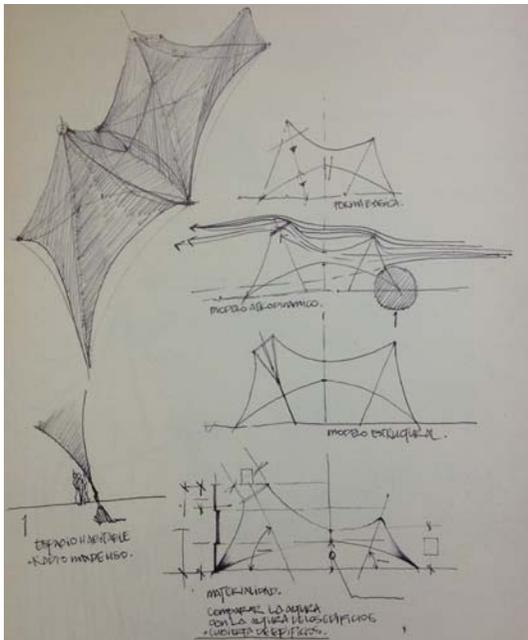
JC. Olivas. Croquis planteamiento de estructura y mantos tensiles, posible comportamiento del aire y las propuestas de ventilación para estas áreas.2012.
